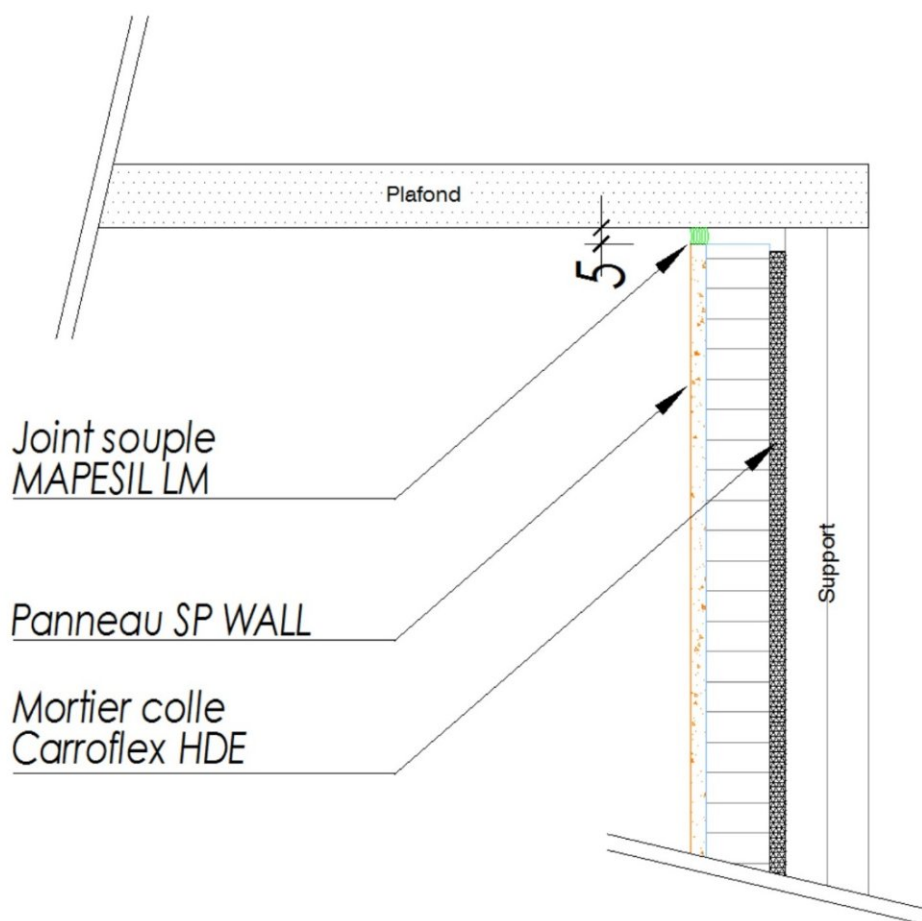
Traitement du raccord entre SP WALL et le plafond
